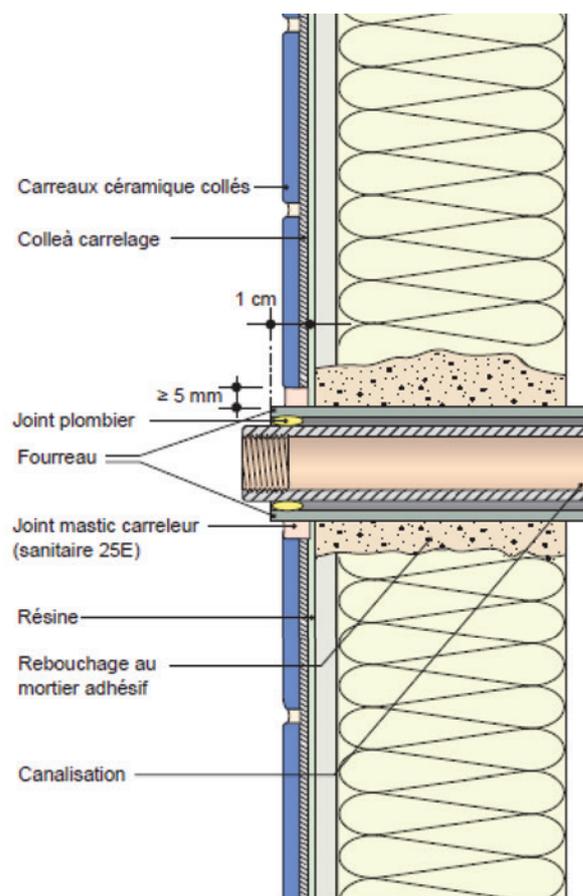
Traitement d'une canalisation traversante avec fourreau en paroi verticale ; exemple d'une cloison en plaque de parement en plâtre
